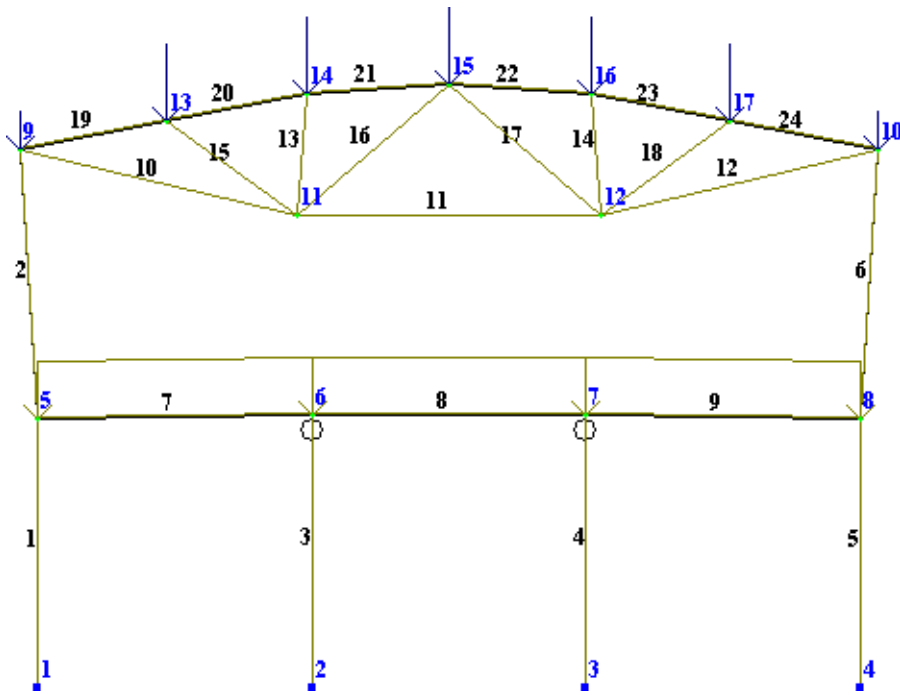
Расчетная схема с учетом перемещений узлов [Вывод на экран эпюр](#)
